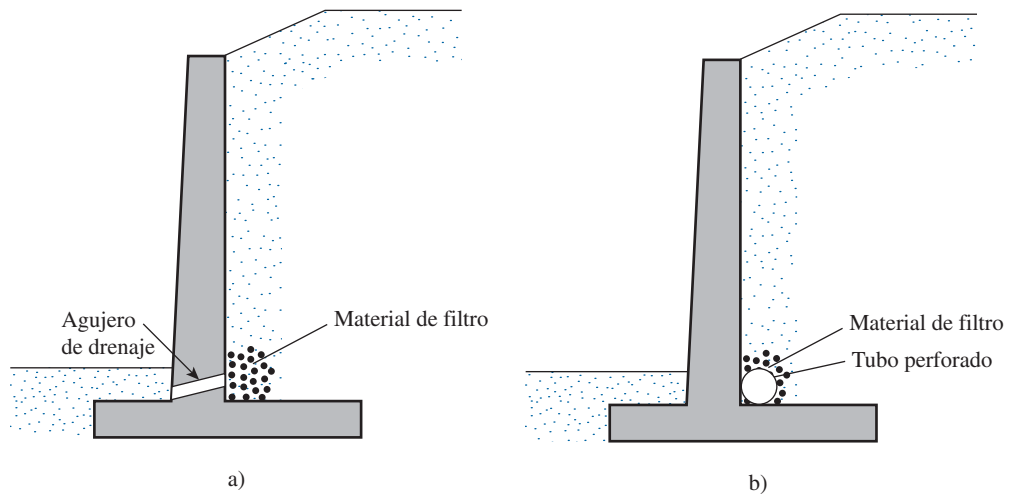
Provisiones de drenaje para el relleno de un muro de retención: a) agujeros de drenaje; b) mediante un tubo perforado de drenaje.
